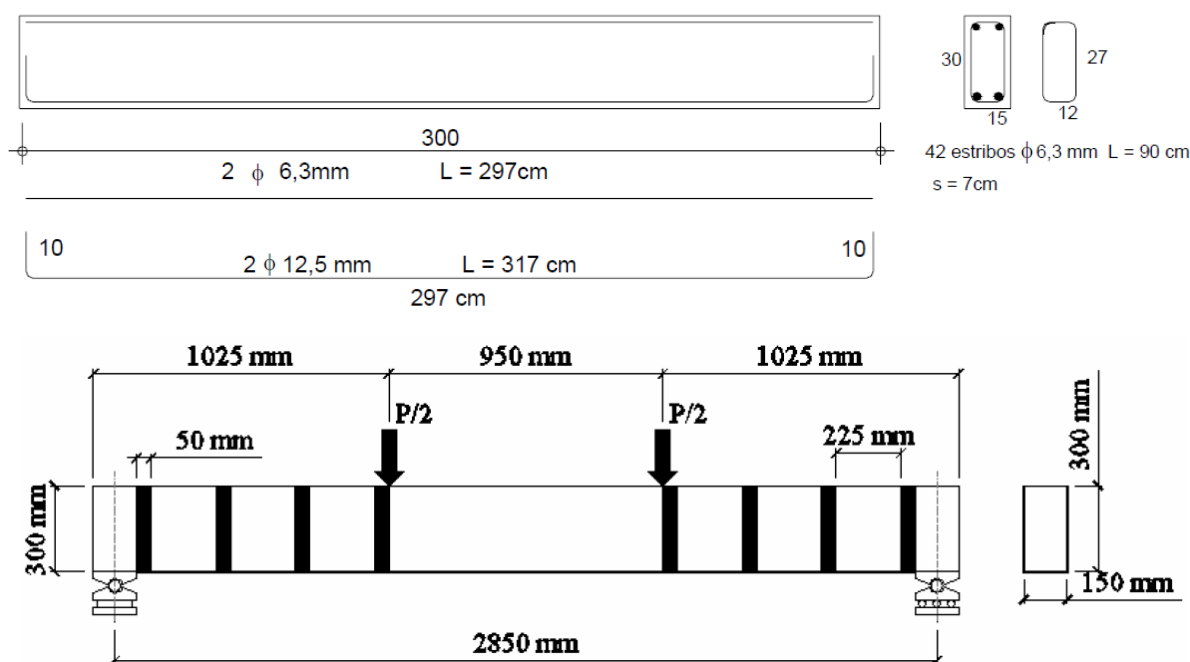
Detalhes e esquema de carregamento das vigas do grupo IIB (Meneghetti, 2007)
